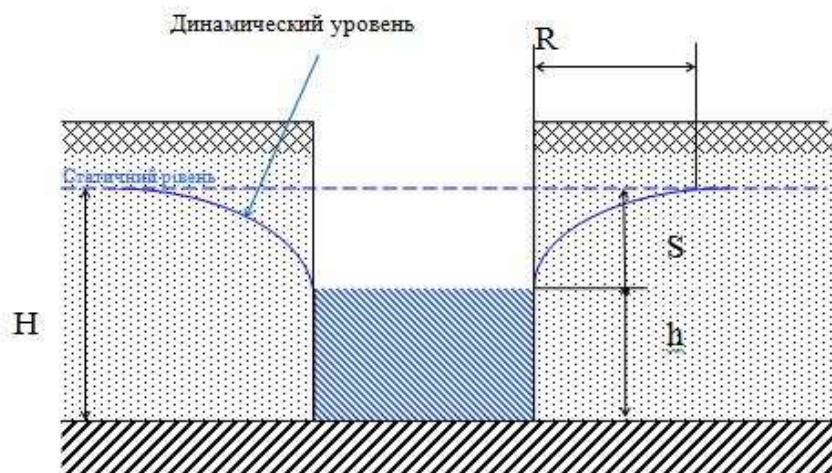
Схема притока грунтовых вод к совершенной траншее
